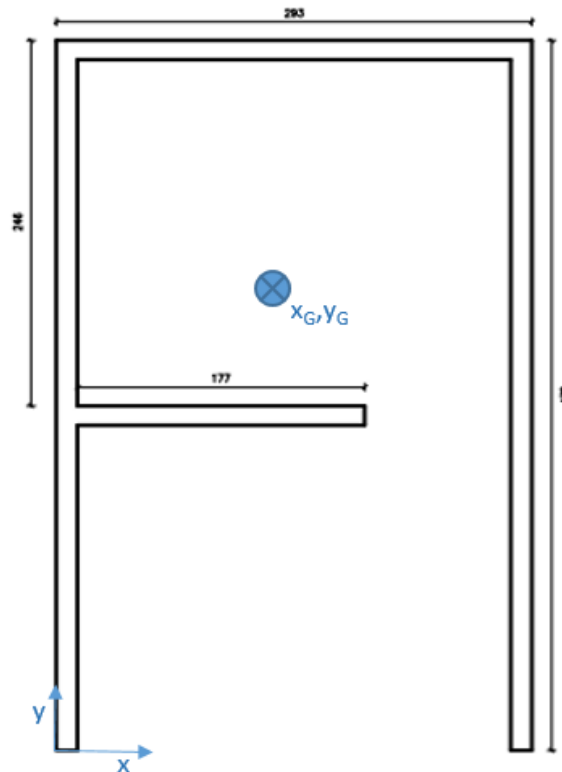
Geometría Núcleo en planta baja en cm - espesor: 13cm
